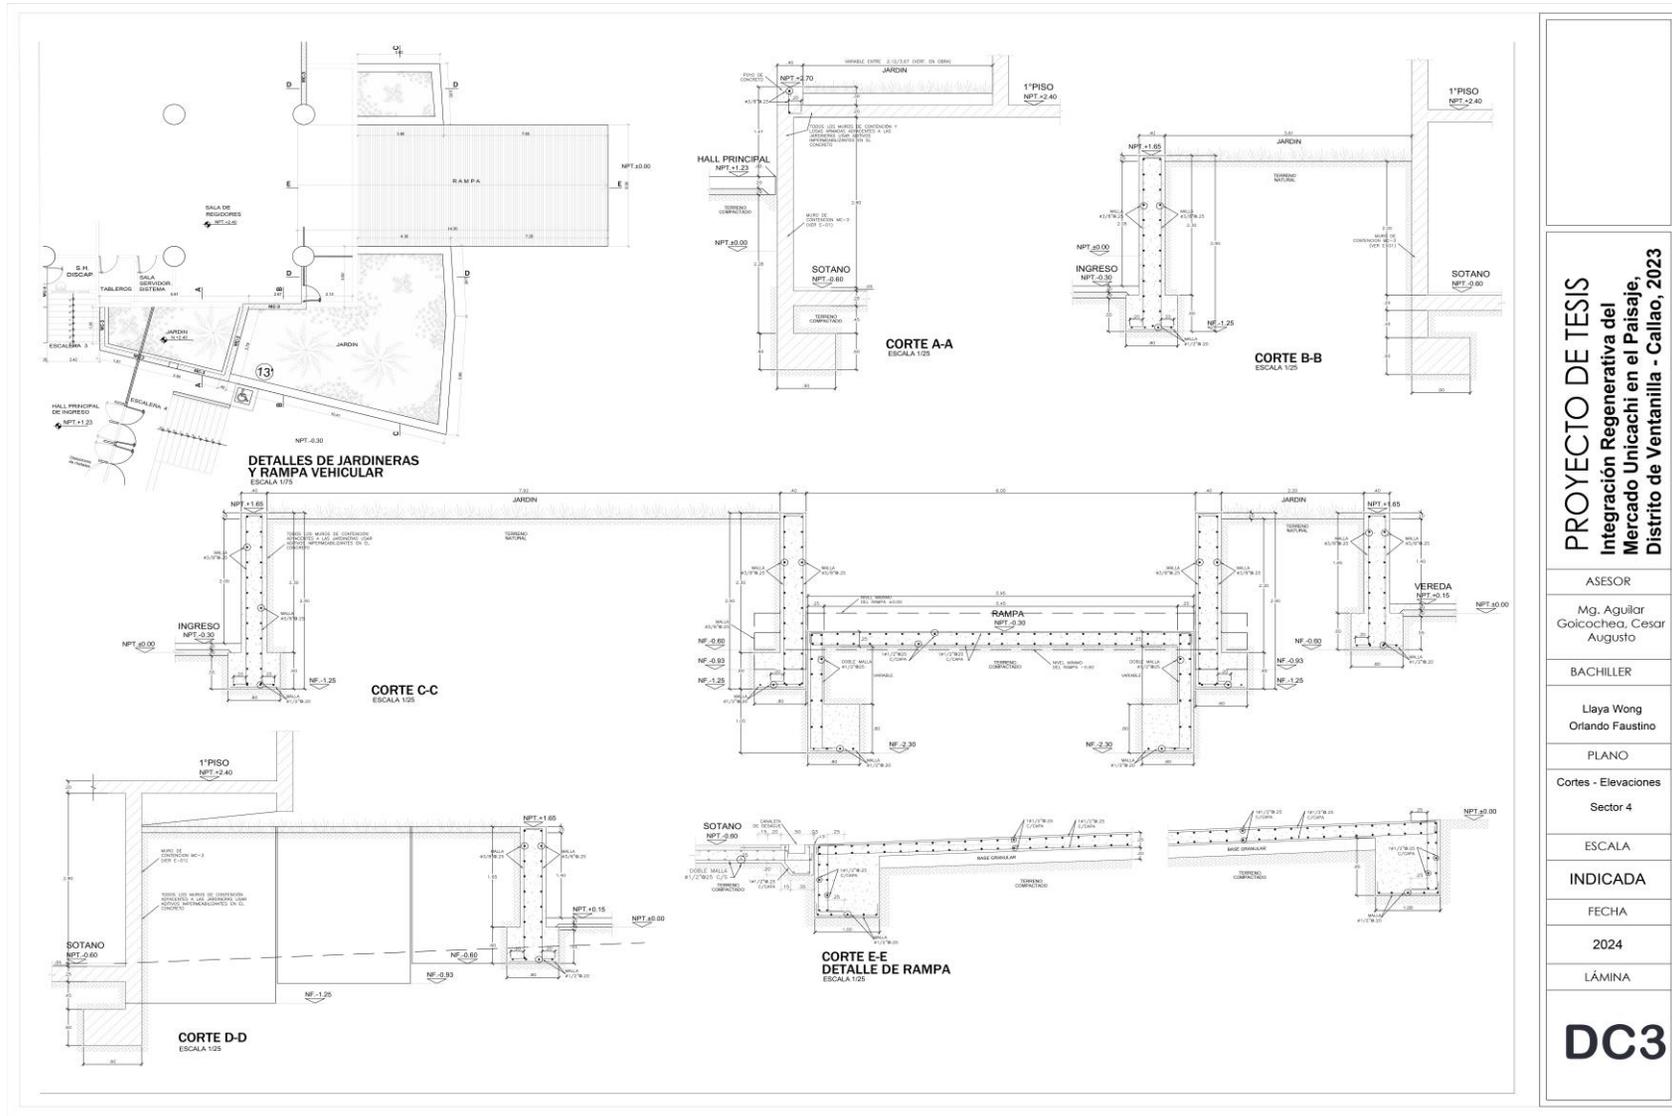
Plano de Detalles Constructivos de Jardinera y Rampa Vehicular, elaboración propia.
